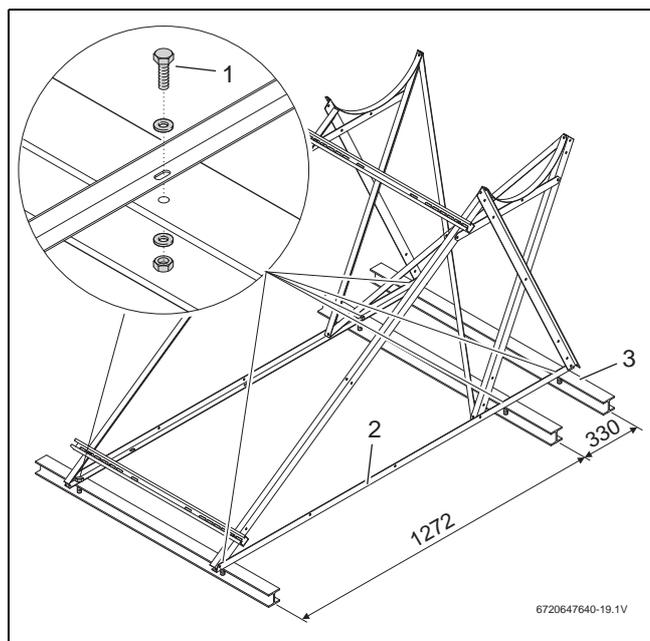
Estrutura para telhado plano fixa sobre viga em I, medidas em mm (aqui no sistema de 150/200 I)
